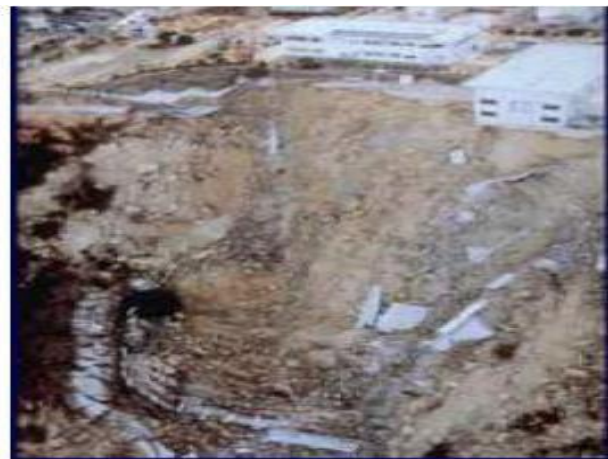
Séisme de Kobé, Japon 1995 [13]
